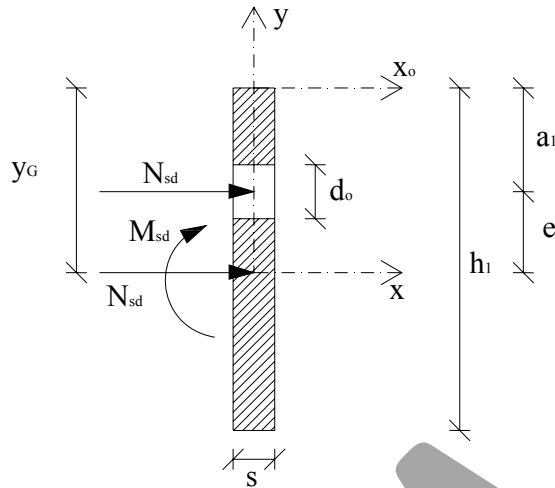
Geometria della sezione resistente offerta dalla piastra d'attacco
